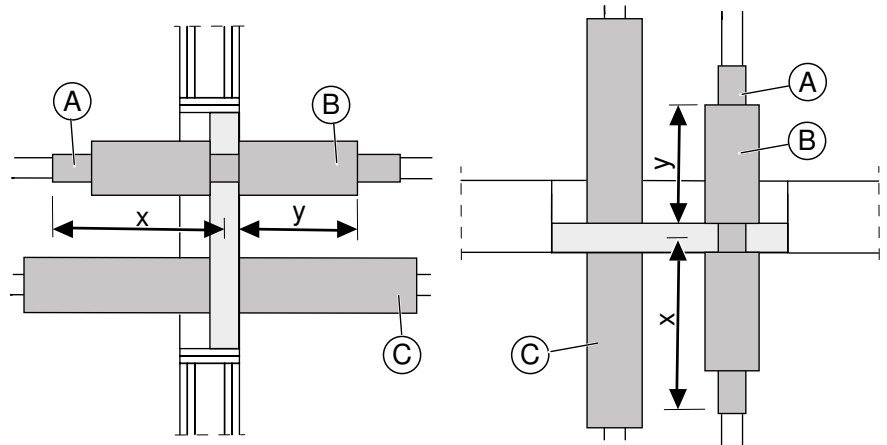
Strecken- und Schutzisolierung an nichtbrennbaren Rohren in Wand und Decke
